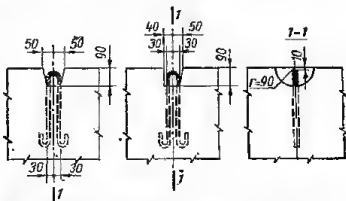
Установка монтажных петель в сборных элементах, изготовляемых с заглаживанием поверхности механическим способом.
